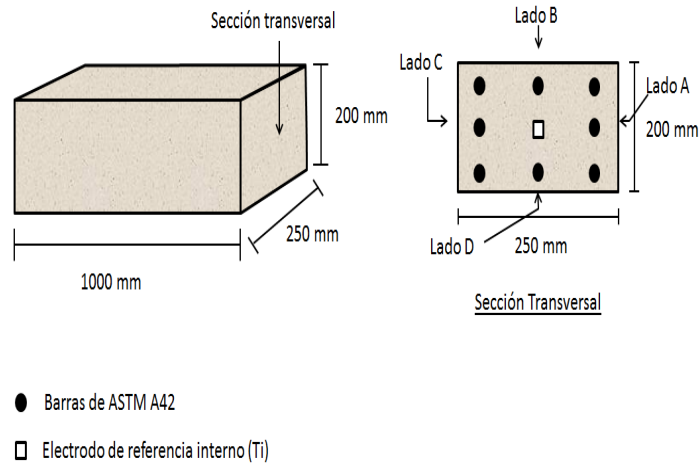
PROBETAS RECTANGULARES DE HORMIGÓN CON BARRAS DE ACERO.
